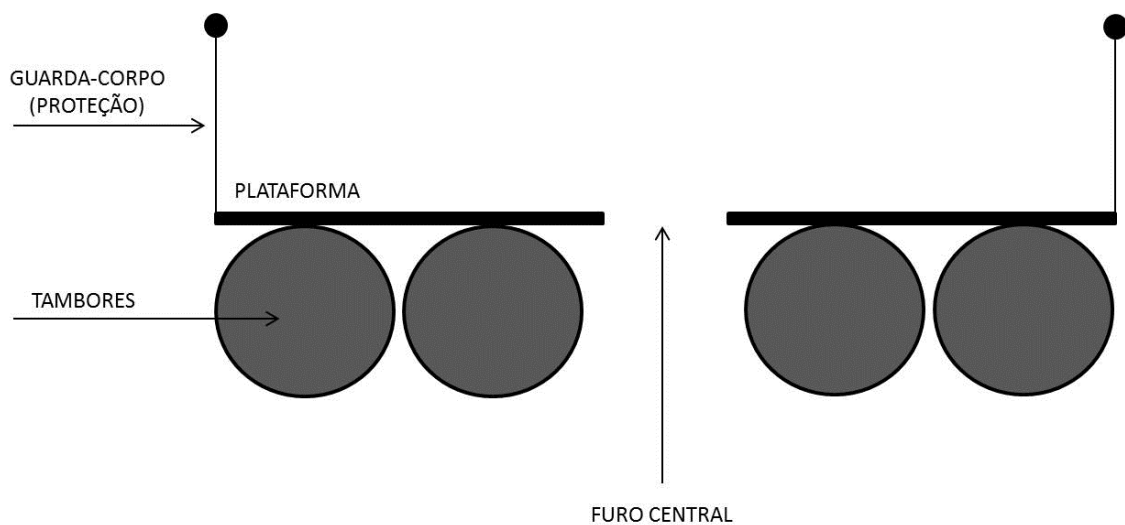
Desenho em perfil da balsa proposta para a sondagem piezométrica
